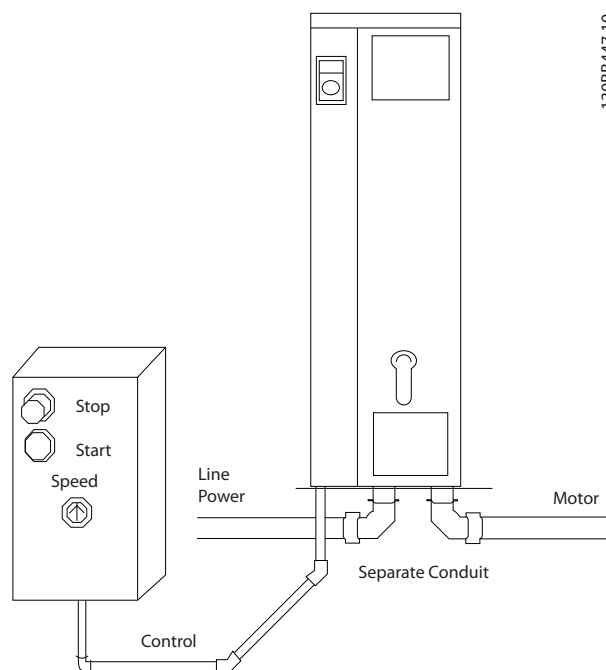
Installation électrique correcte à l'aide d'un conduit
